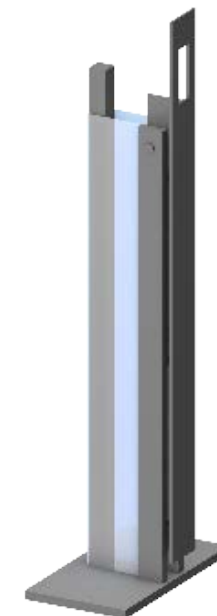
Vorentwurf I, Grundriss Stütze im eingeklappten Zustand
